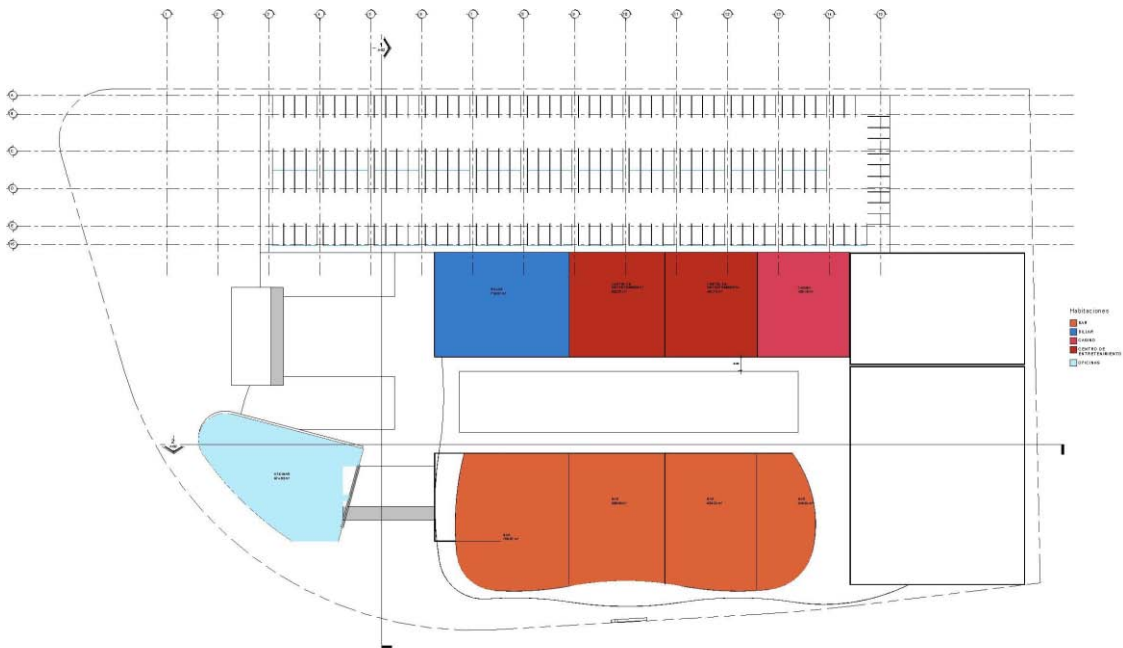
PLANTA SEGUNDO NIVEL
